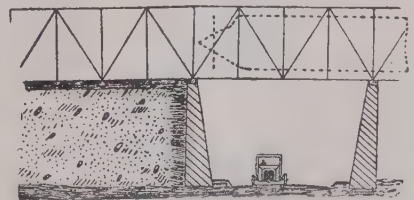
Paso superior del Aéreo Tracto-Carril
